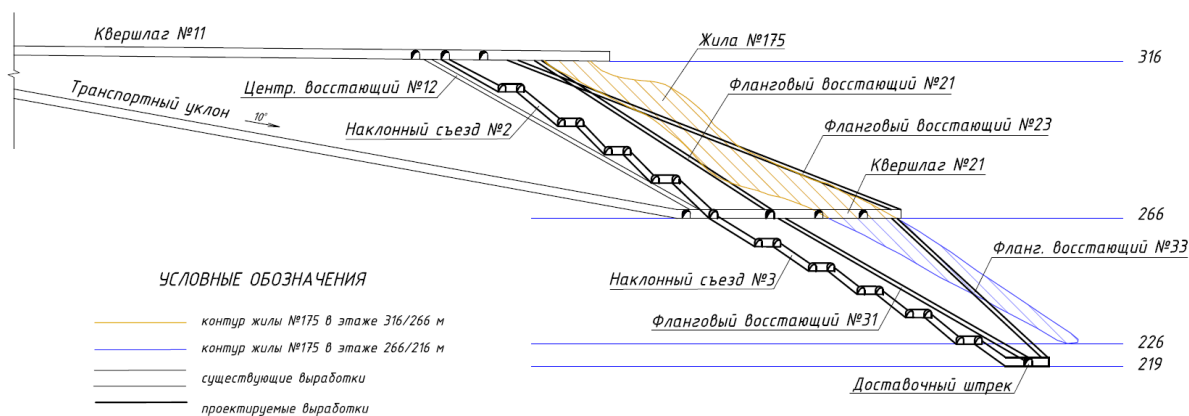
Схема вскрытия нижних горизонтов жилы № 175
